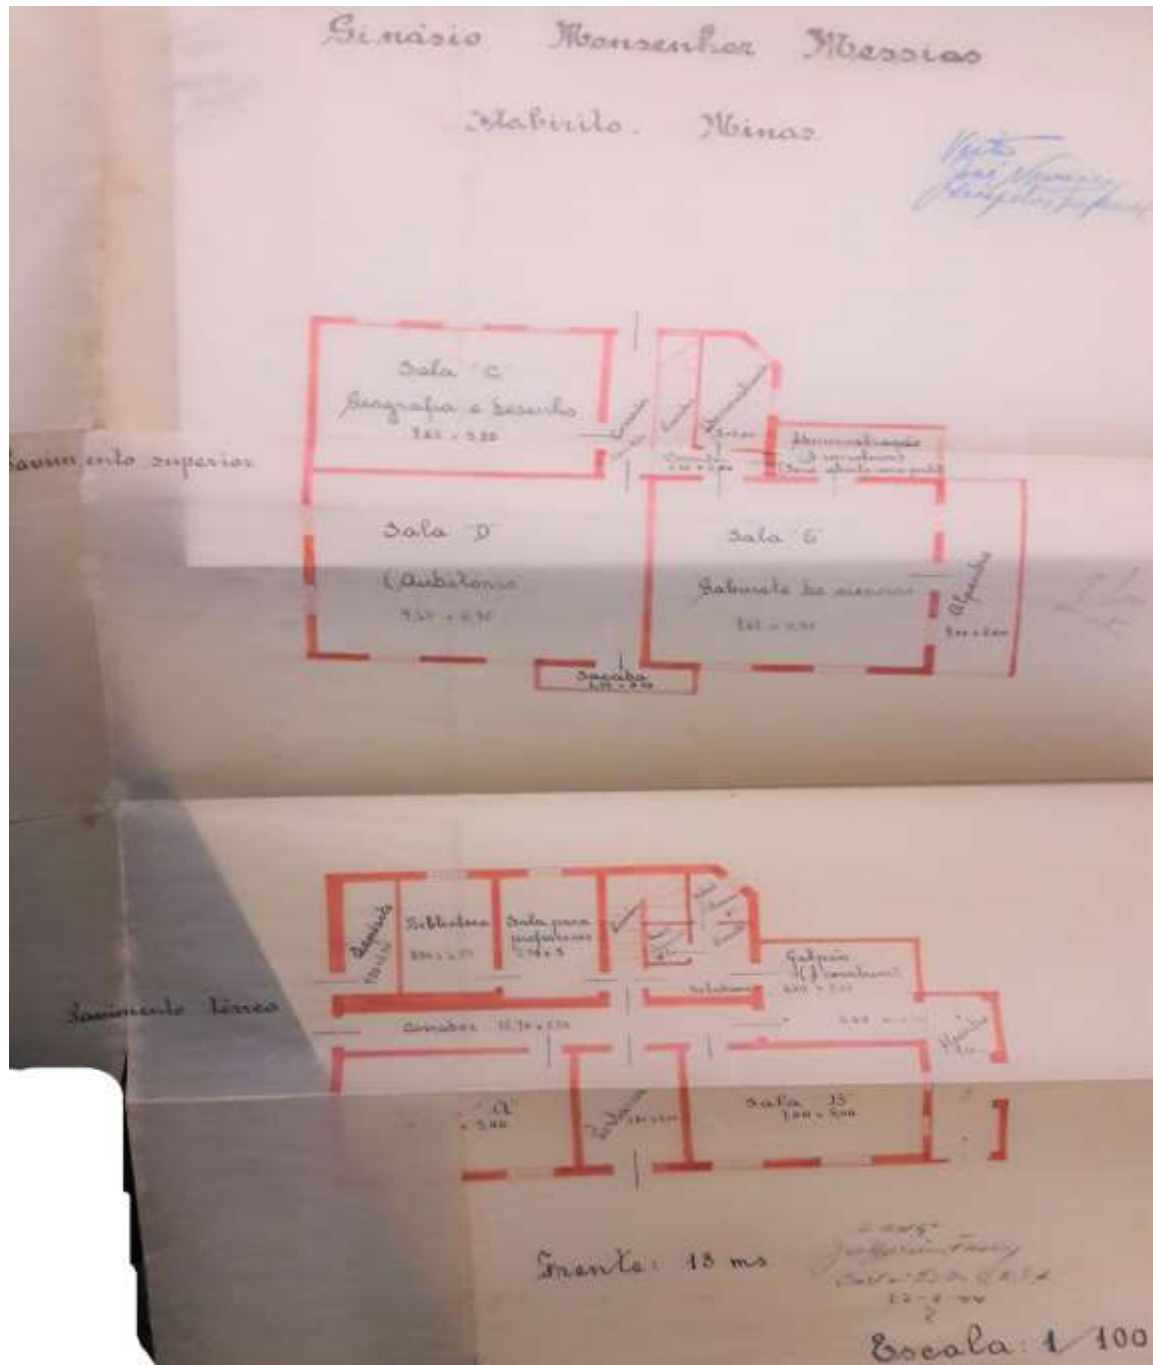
Primeira planta baixa do primeiro pavilhão do Ginásio Monsenhor Messias.
